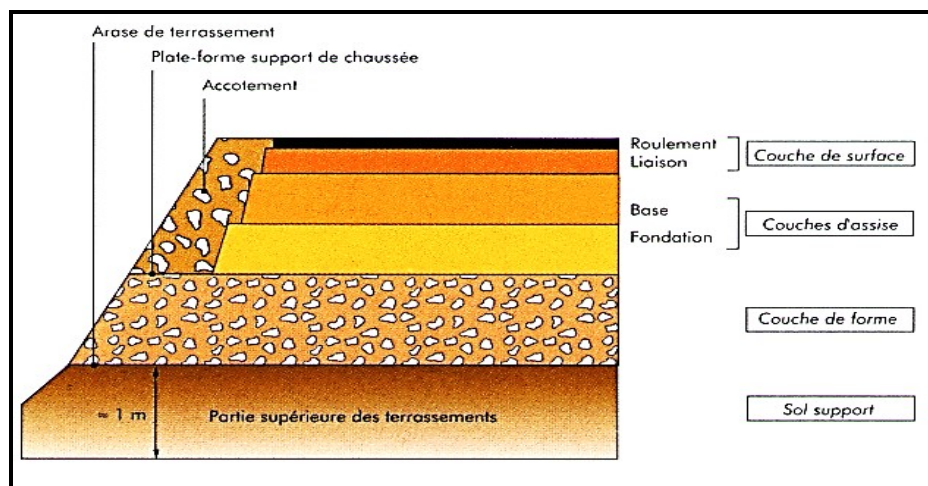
Différentes couches et structure de la chaussée souple [14]
